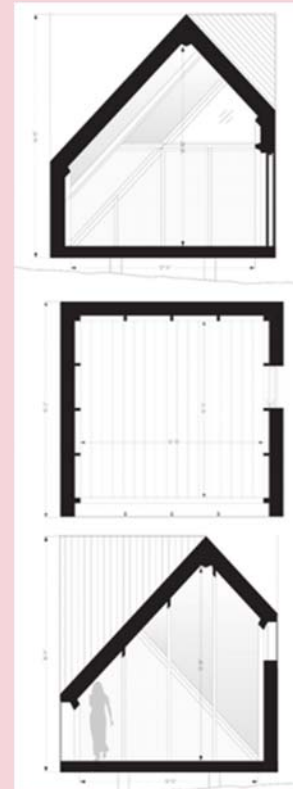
Casa Pequeña (Tiny House) A45. Cortes y Planta. Construmática (2017)
